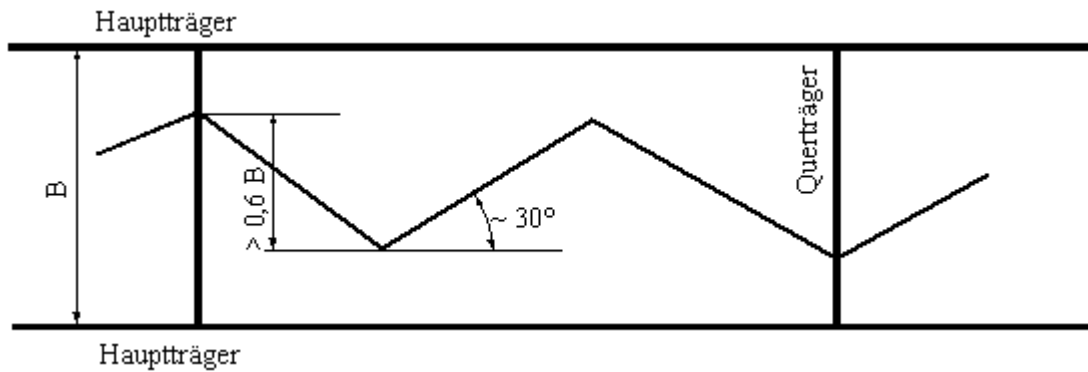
Grundriss einer Brücke (schematisch) mit vertikalen Einbauten (z.B. Drahtgewebe)
